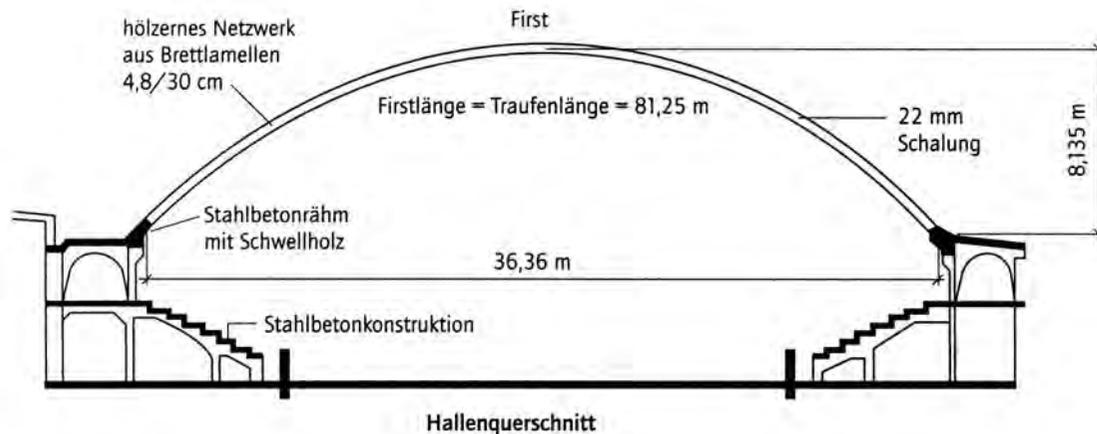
Halle Münsterland, Münster, Querschnitt und Zollinger-Dachlamellen, aus /122/
